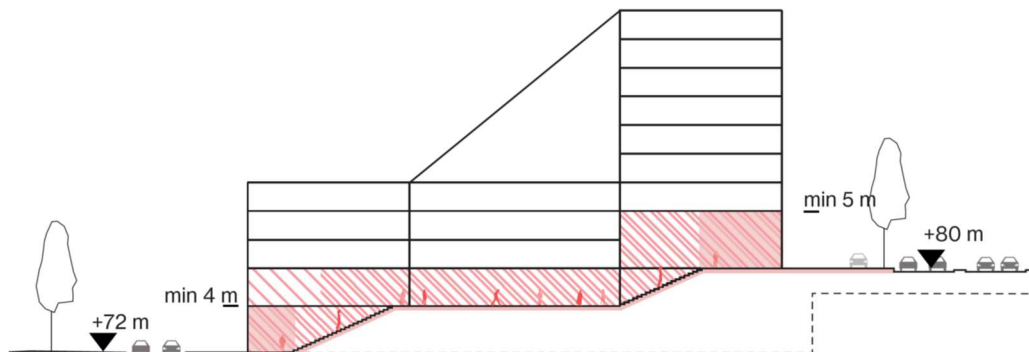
Différence de niveau entre le boulevard urbain et l'avenue de Beaulieu (ORG, 2018)
